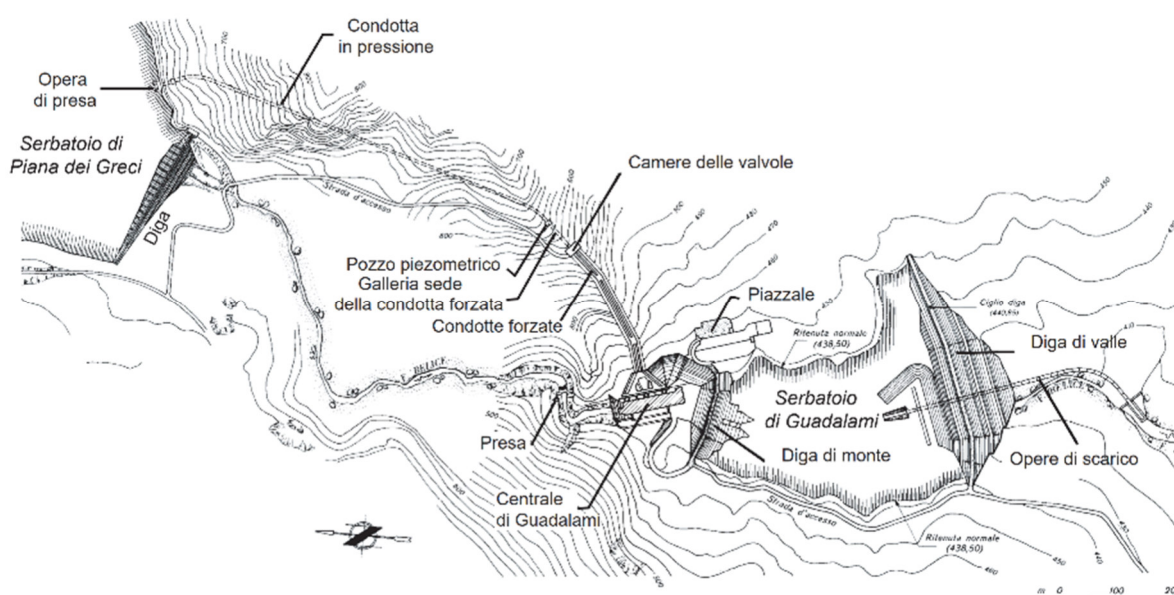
Planimetria generale dell'impianto idroelettrico di Guadalami tratta da scheda ANIDEL [1][2] (parz. ridisegnata)
